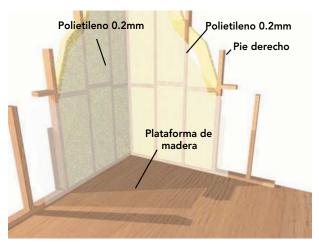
25: Fijación de barrera de vapor por el paramento interior del tabique perimetral, luego de colocada la aislación térmica.
